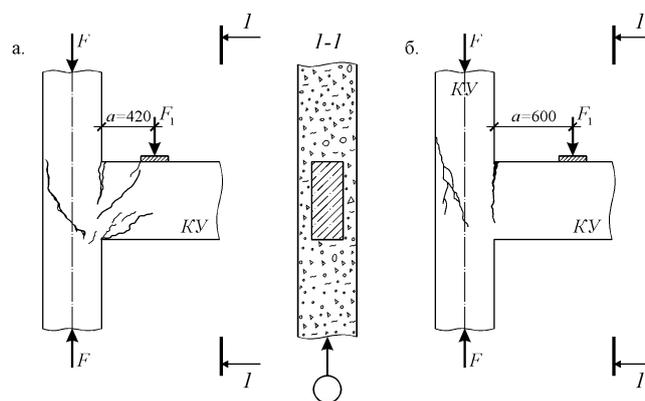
Схемы образования трещин и схемы разрушения узловых сопряжений железобетонных конструкций
